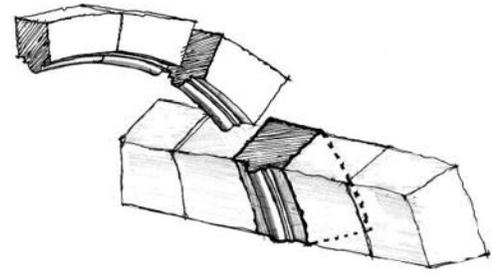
Sillar labrado aparentemente a la manera prehispánica. Muro poniente del ex convento de Tzintzuntzan.
